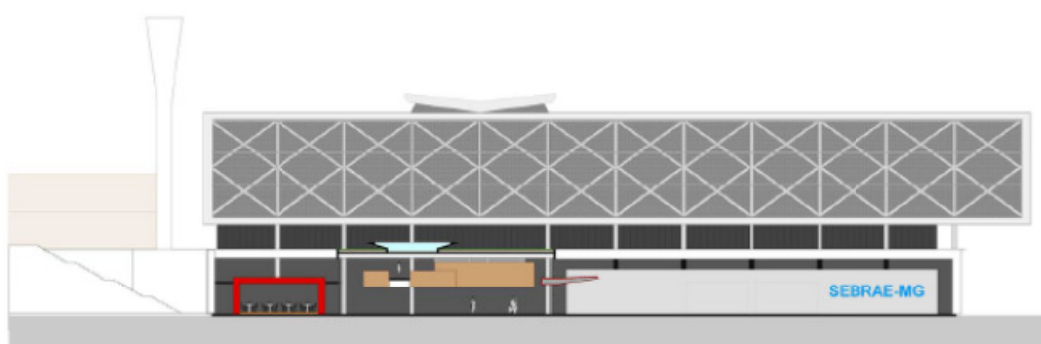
Fachada extraída da prancha 08 do projeto Sebrae/MG.
